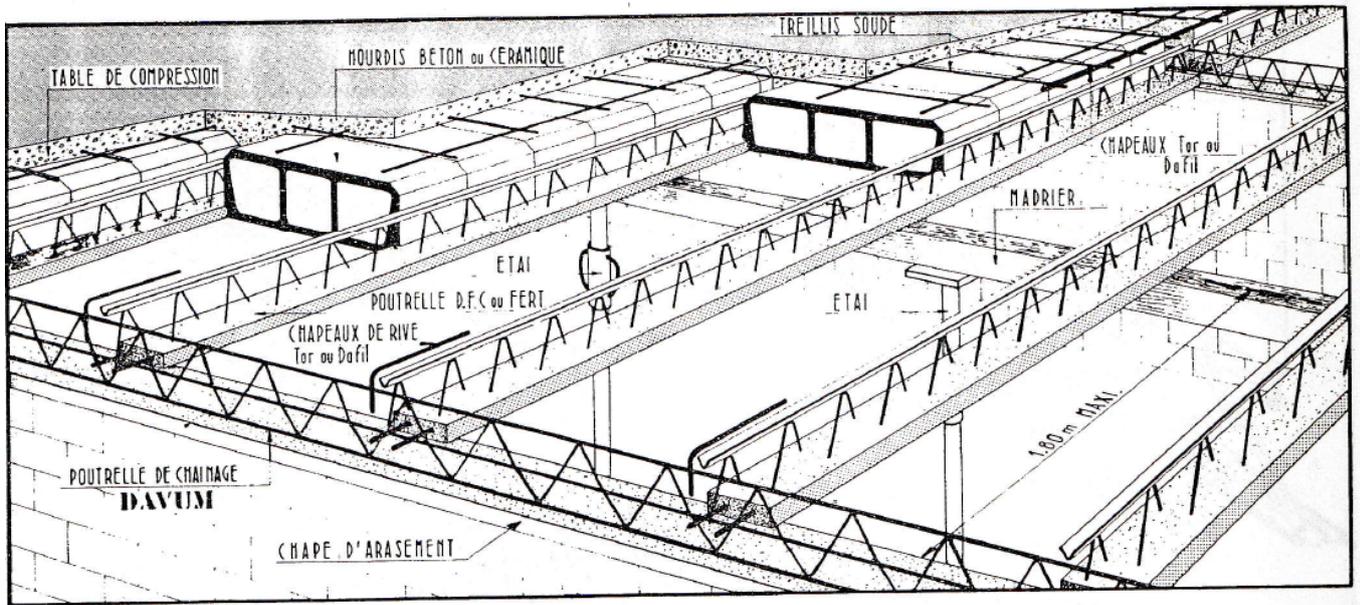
Coffrage traditionnel pour plancher à corps creux
